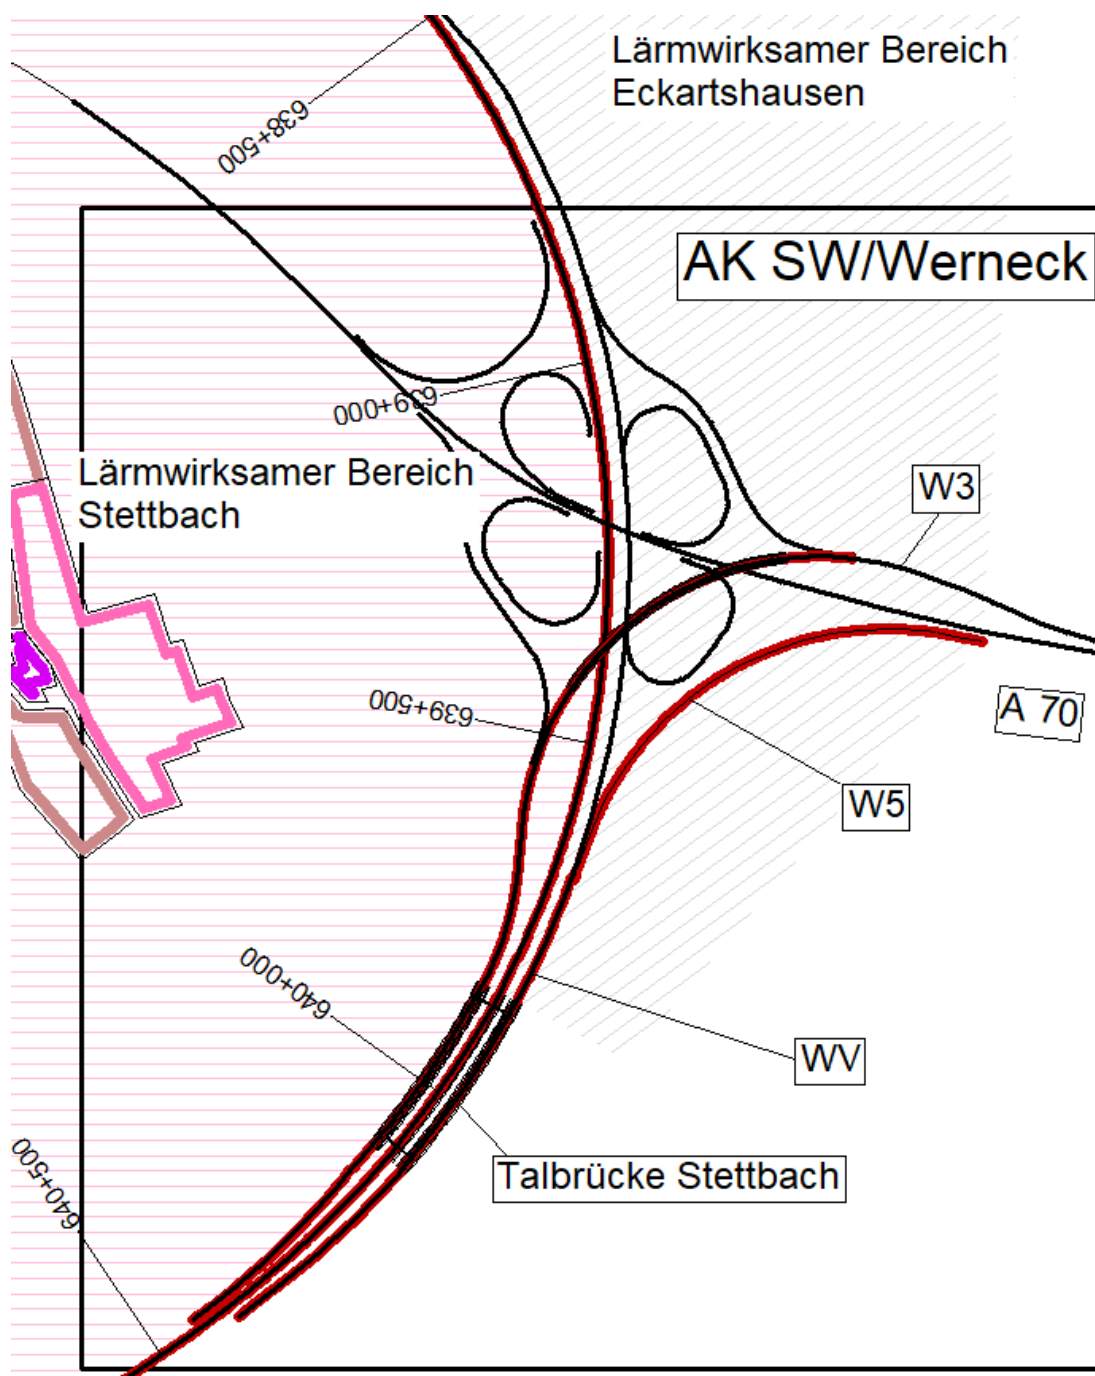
Systemskizze Fahrbahnbelag (k) – Detailausschnitt AK SW/Werneck
